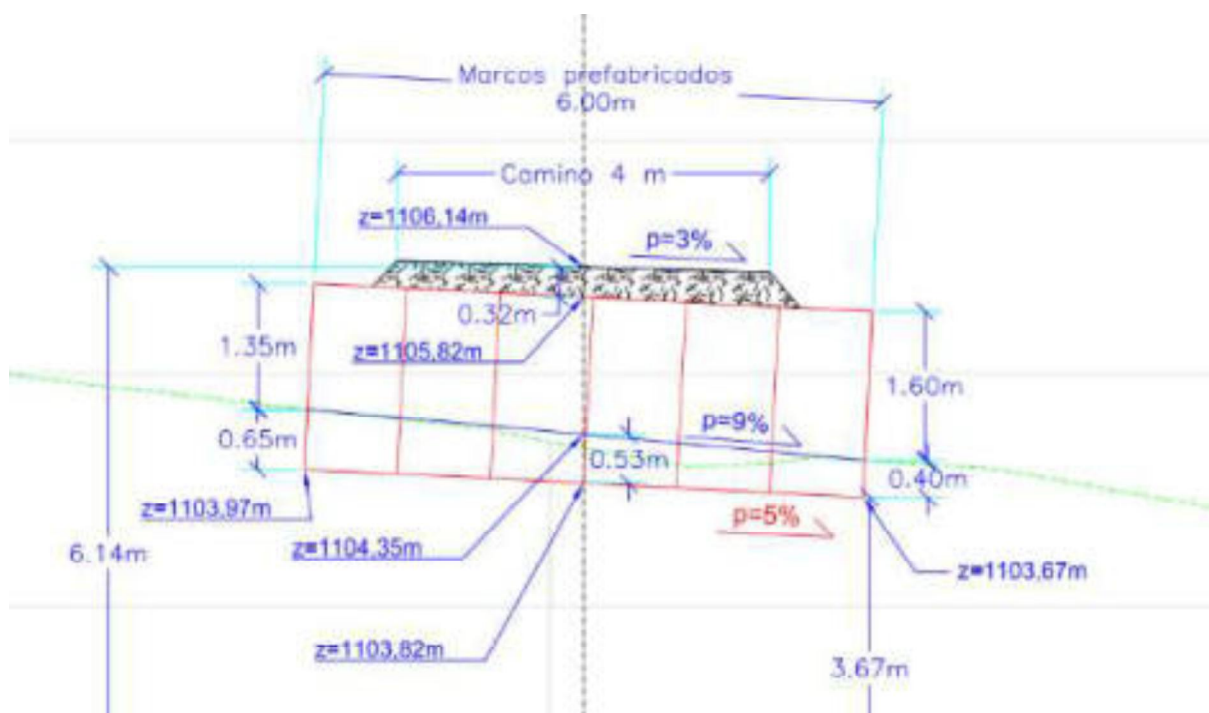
Perfil del Barranco según el levantamiento topográfico realizado con los marcos colocados.
